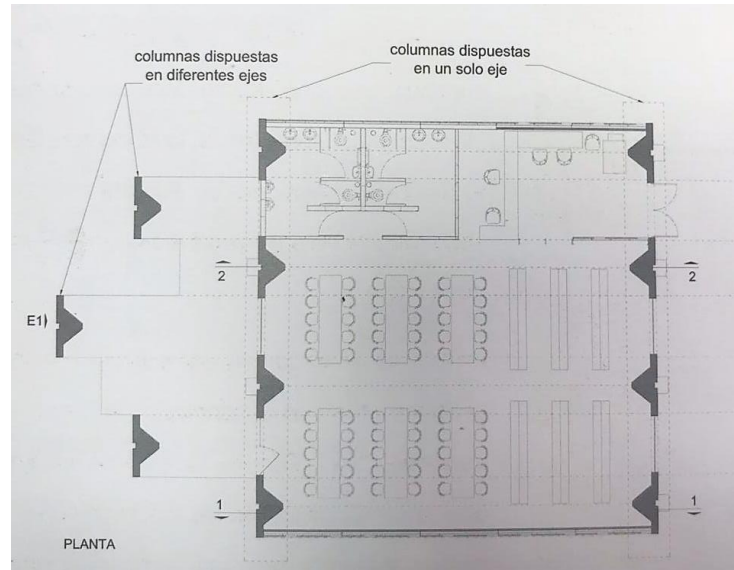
Planta emplazamiento de la arquitectura con la estructura - Sistema porticado
